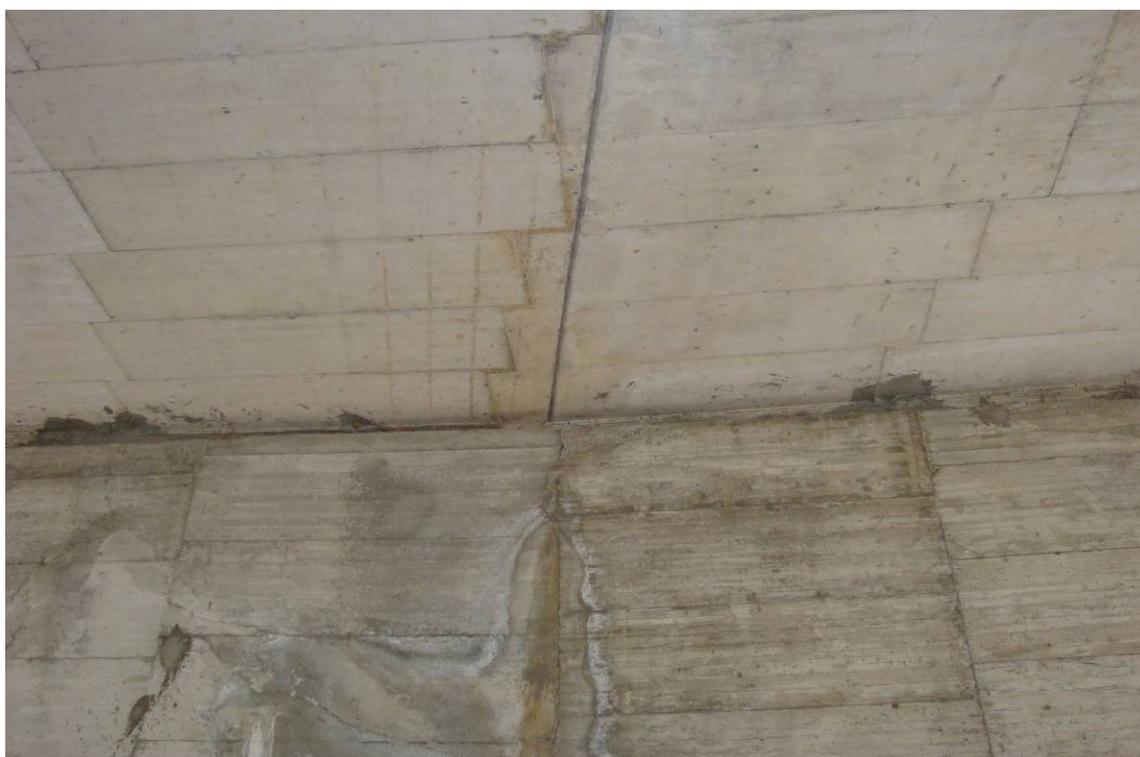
Vista attacco solettone – spalla: infiltrazioni
